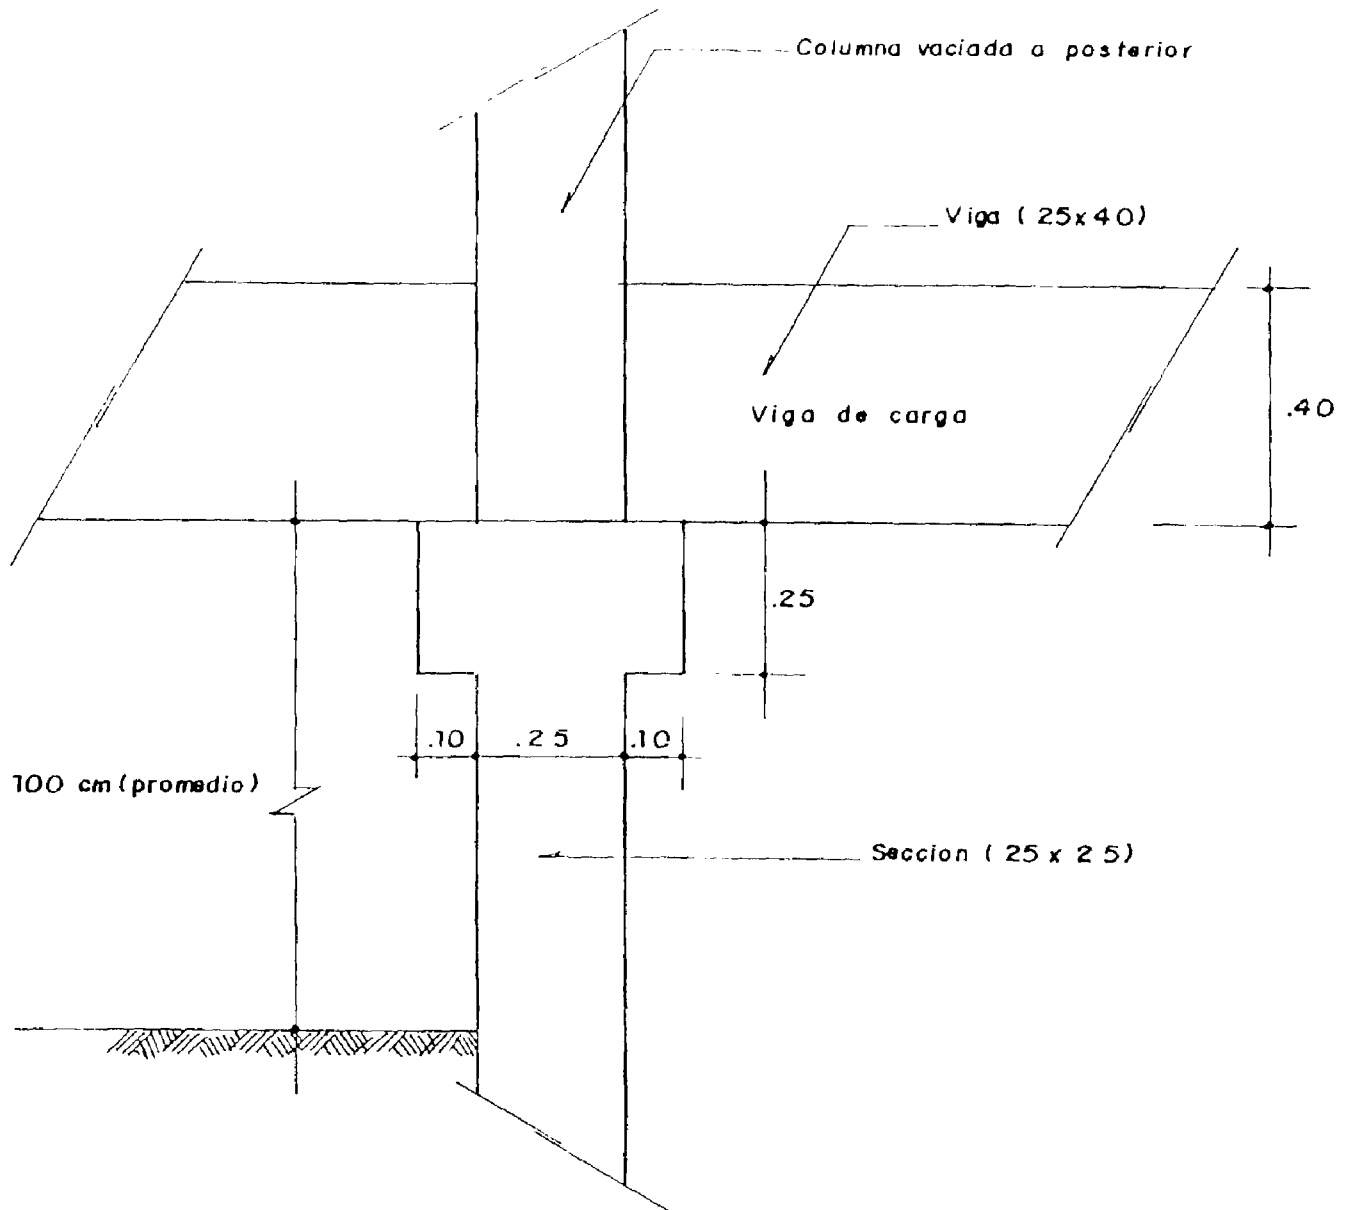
DETALLE DE LA UNION DE LAS VIGAS DE CARGA
